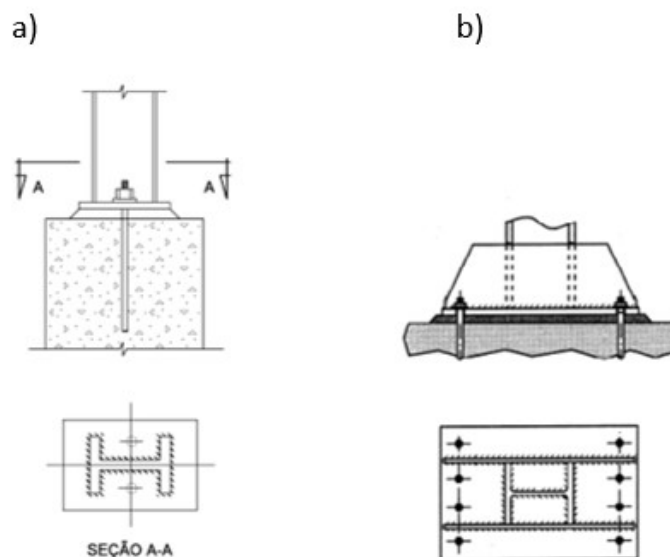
a) Representação de uma ligação da base de pilar articulada; b) Ligação rígida (adaptado de [47])
